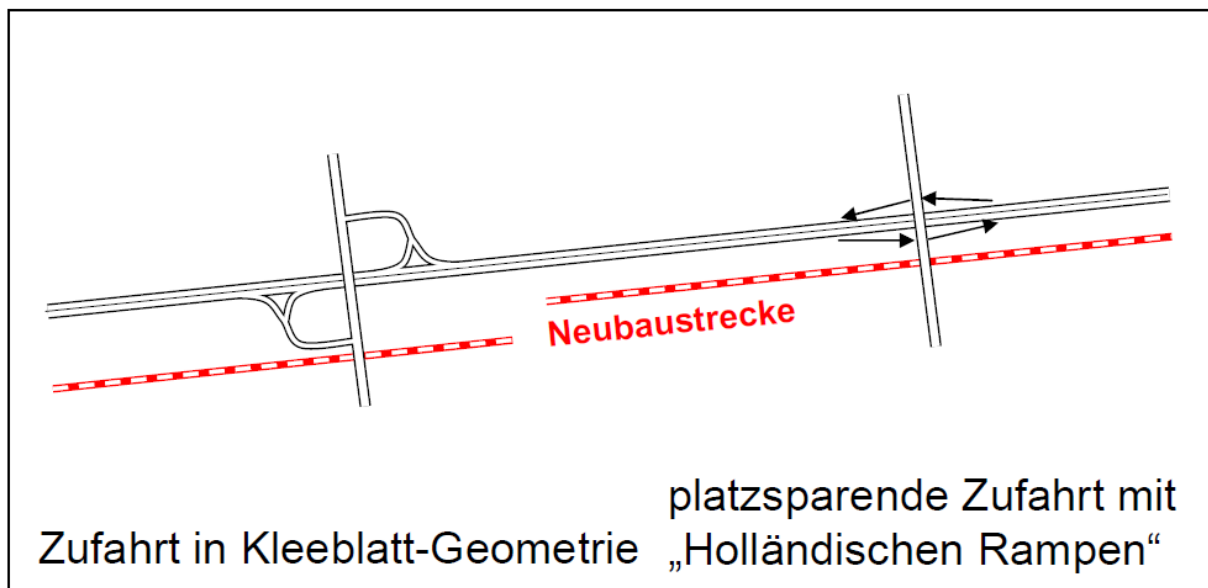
Enge Parallelführung der Neubaustrecke durch Umbau der AAutobahnzufahrten auf „Holländische Rampen“; eigene Darstellung, 2015
